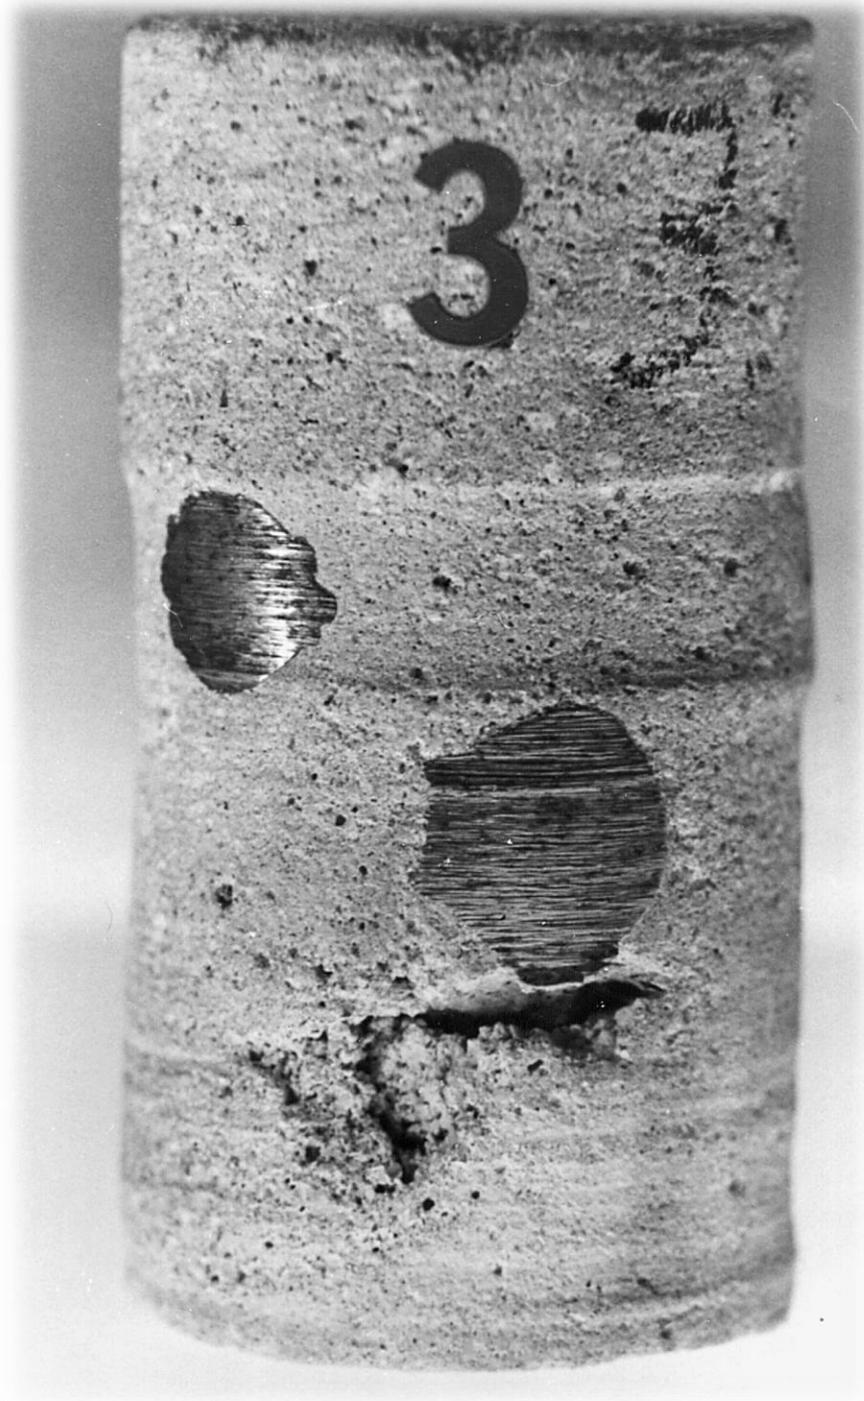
"Grado 3". Fuente: (American Concrete Institute, 1995)
